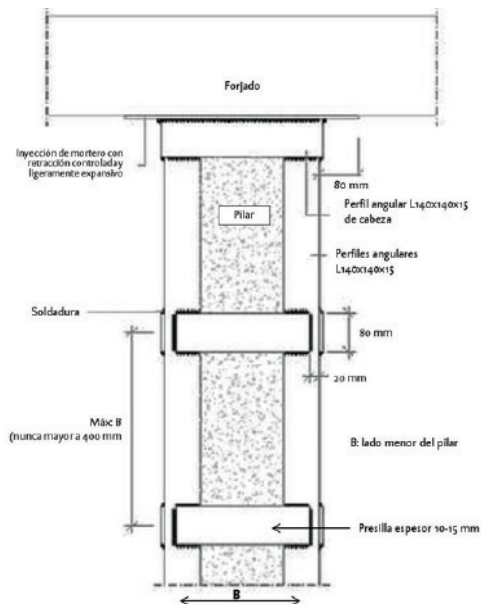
Condiciones y medidas para la aplicación del empresillado en columnas de hormigón.
